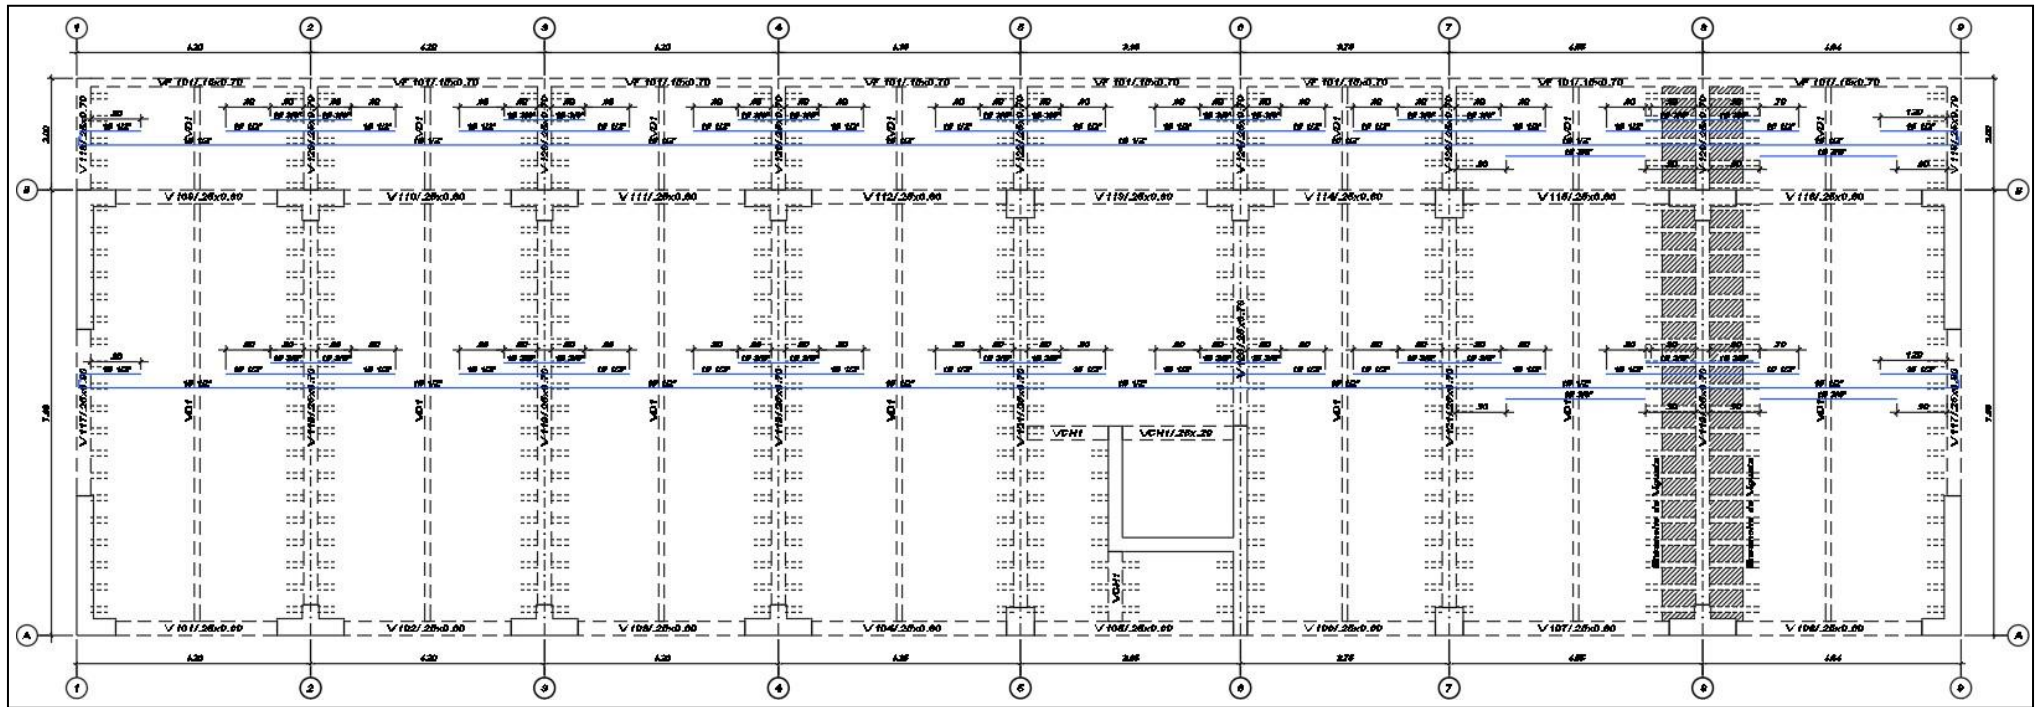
Encofrado típico de 1°, 2° y 3° techo
